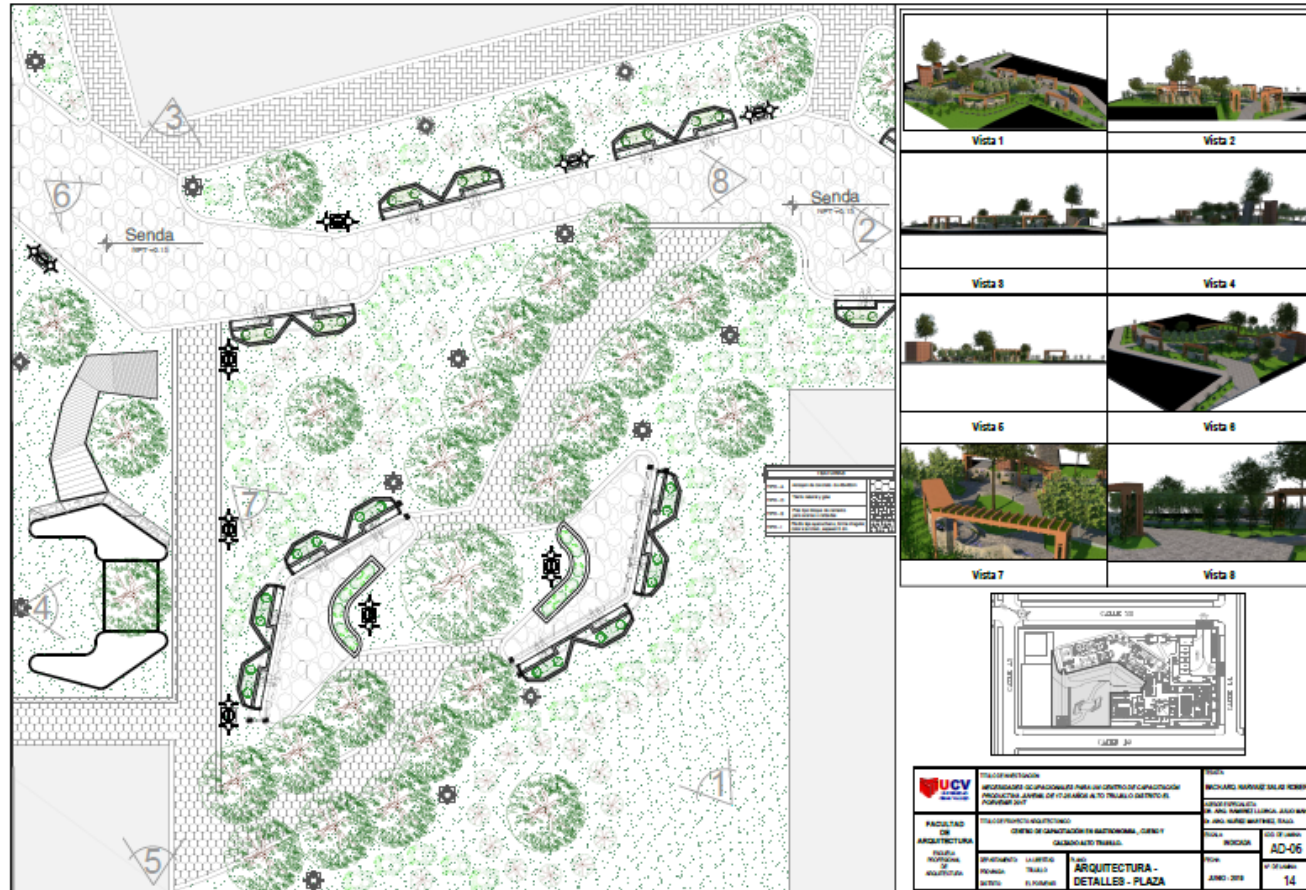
Plano de Detalle Arquitectónico, Planta de plaza -Plano N°14-Lámina AD06
